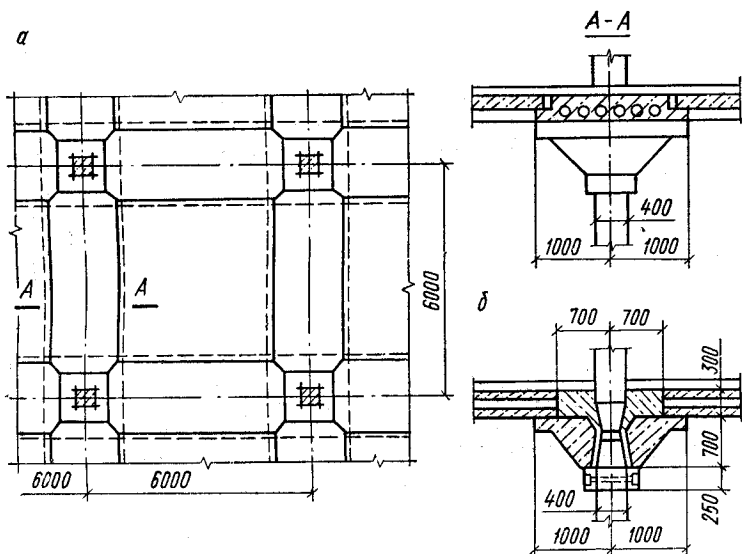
Конструкция безбалочного сборного перекрытия с пустотными панелями
